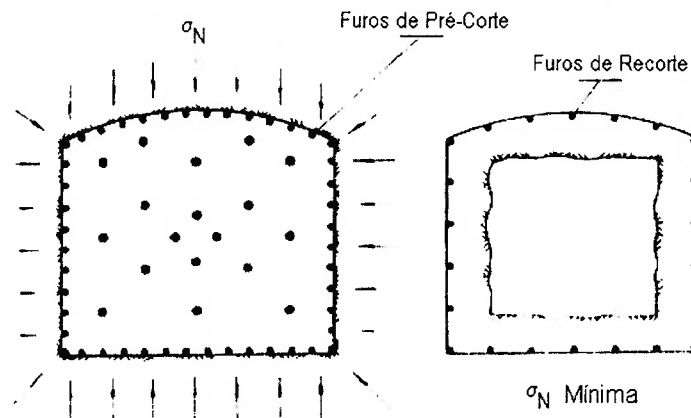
Alívio das tensões mediante a realização de uma escavação piloto
